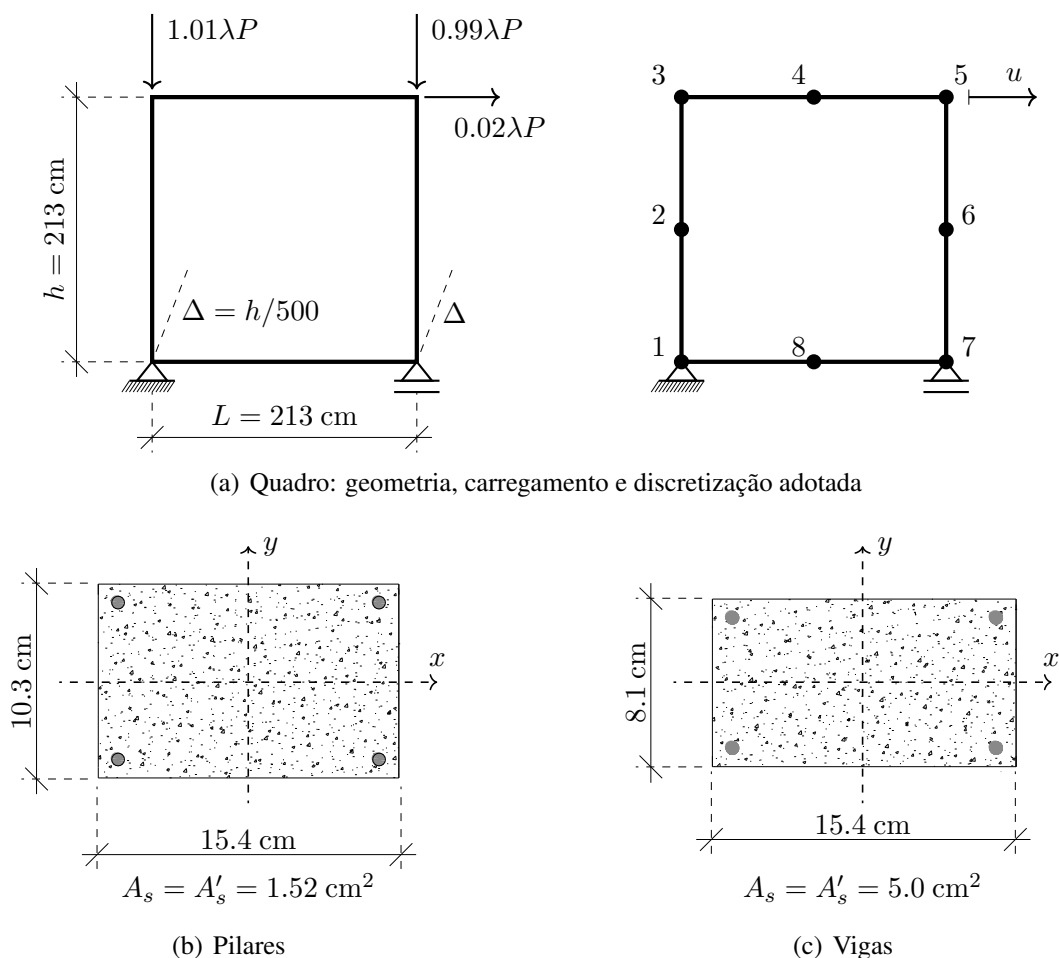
Quadro em concreto armado: geometria, discretização adotada e seções transversais
